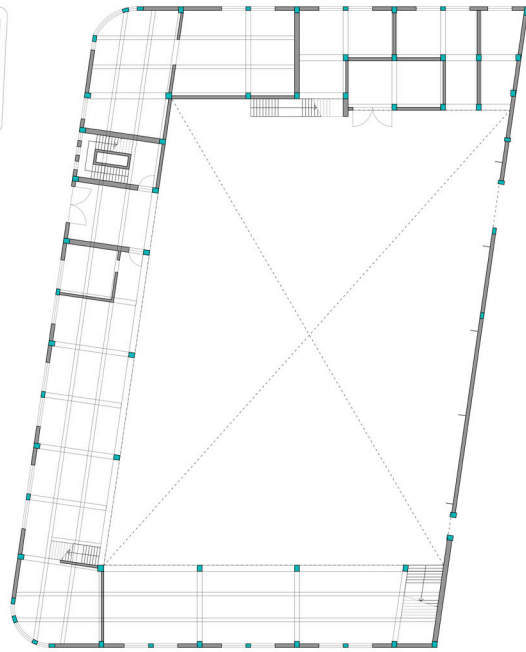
Plantimetría Galpón Norte Ex Fundación Metalco. Fuente: elaboración propia.
